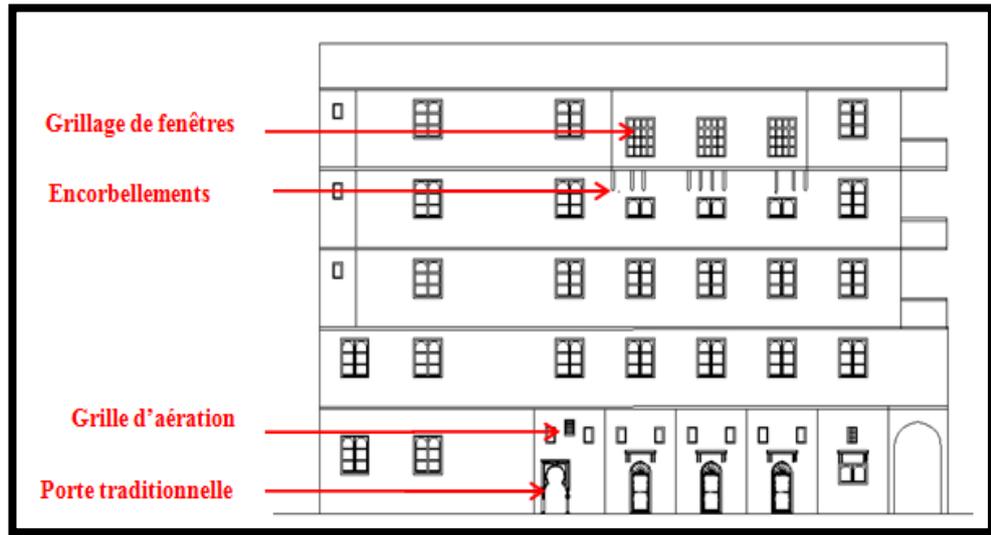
Façade latéral de l'Hôtel (1<sup>ère</sup> variante)
